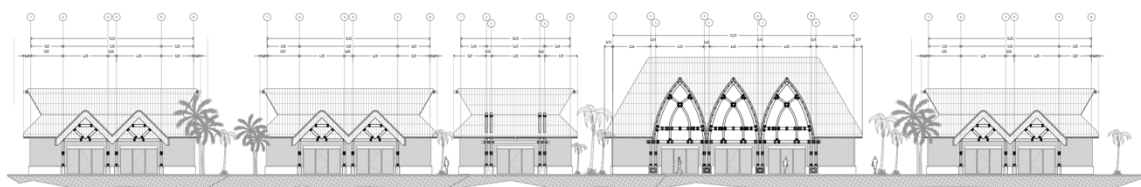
Alzados de los módulos comerciales de un solo nivel a edificar en esta sección.
